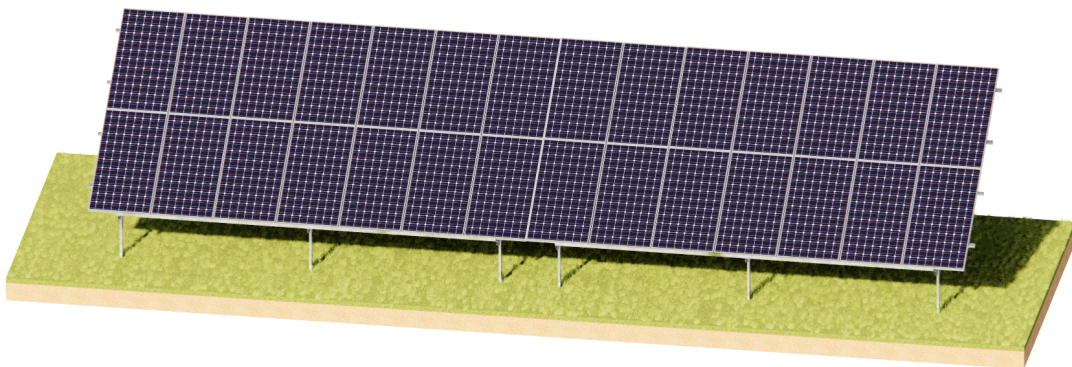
Etapa de instalación de módulos. Fuente: Elaboración propia
